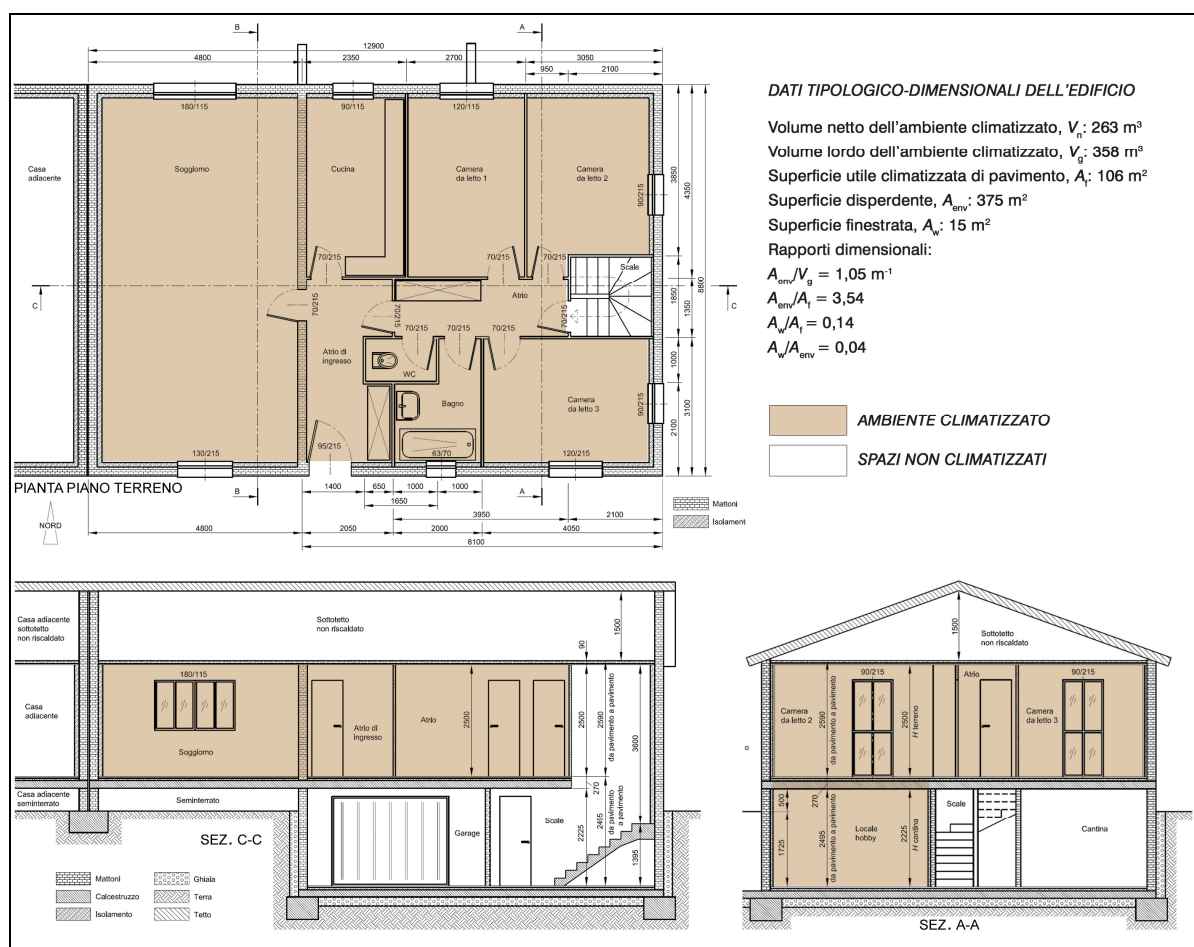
Piante e sezioni dell'edificio oggetto di studio ("Casa Vivaldi", UNI EN 12831).
